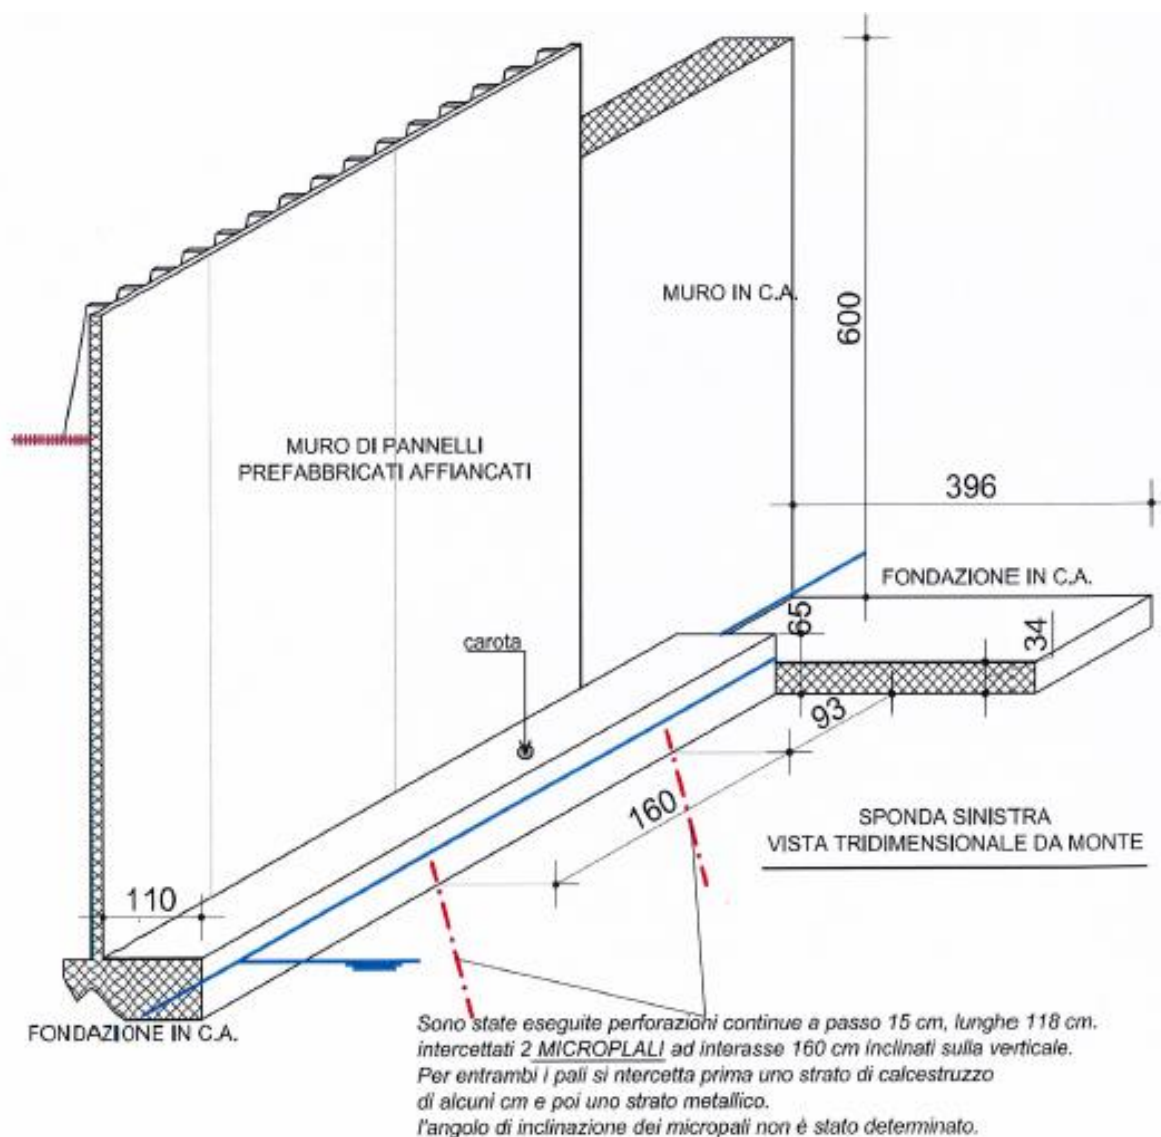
Sezione tipologica strutturale rilevata in sito
